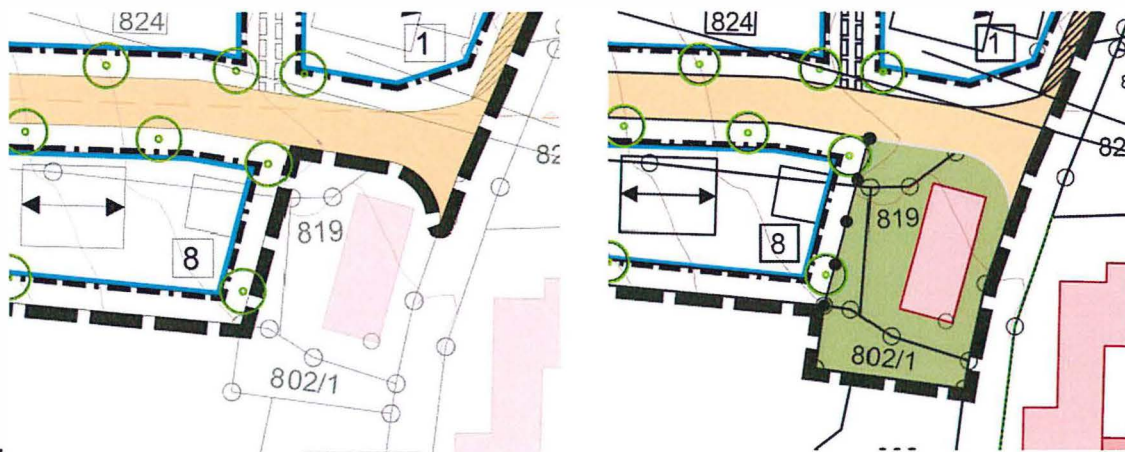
nicht maßstabsgetreue, ausschnittsweise Darstellung der zugrundeliegenden (links) und des geänderten (rechts) Bebauungsplanzeichnung
